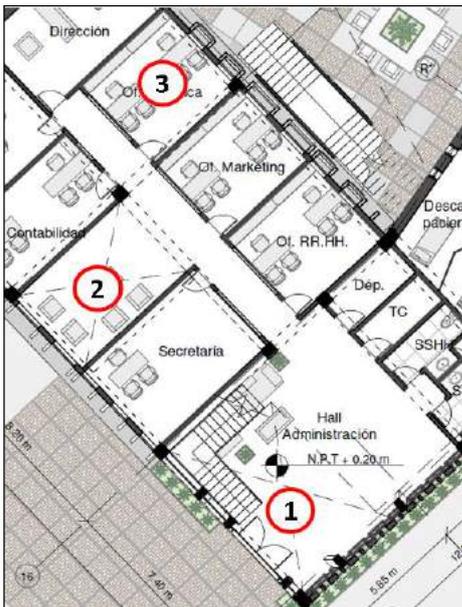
Planta administración – nivel 1. Obstrucciones interiores
